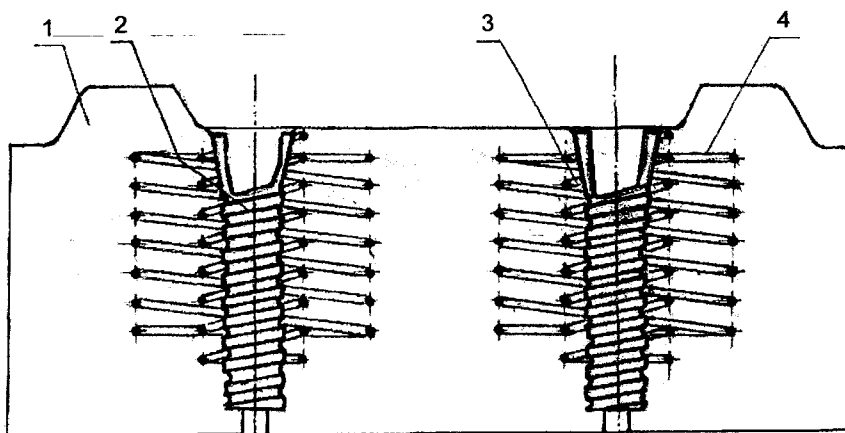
Дополнительное армирование: 1 – подрельсовая часть железобетонной шпалы; 2 – замоноличенный пластмассовый дюбель; 3, 4 – дополнительное армирование (спирали $\varnothing 50$, 100 мм)
